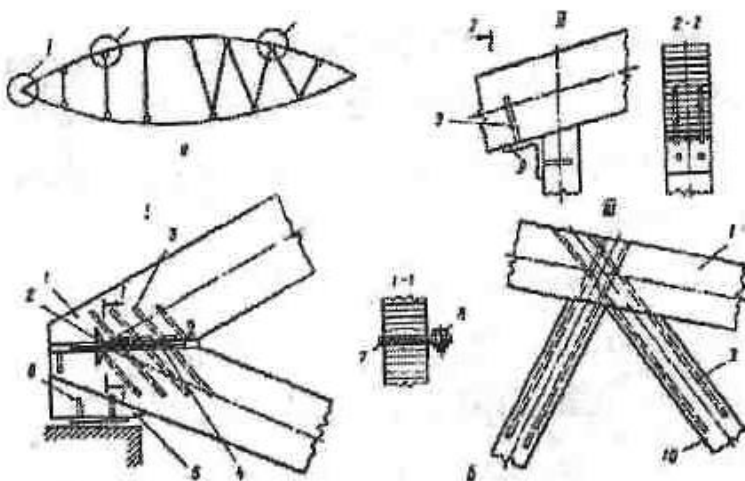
Ферма на вклесених стрижнях: а – схема ферми; б – вузли:
